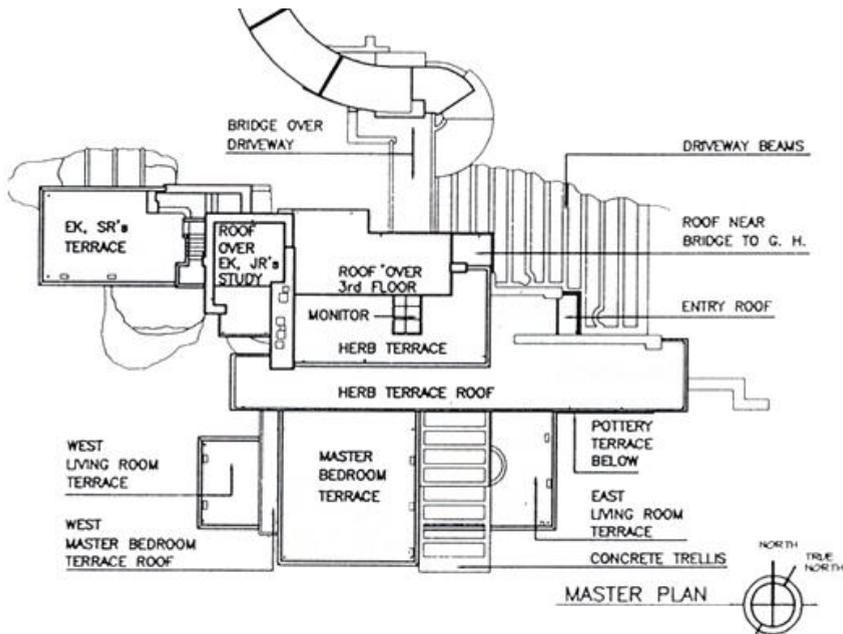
Plano diseño *Casa Cascada*. Fuente: Fallingwater, «Desingning Fallingwater», Fallingwater, acceso web 15 octubre 2018, <https://fallingwater.org/history/about-fallingwater/designing-fallingwater/>
